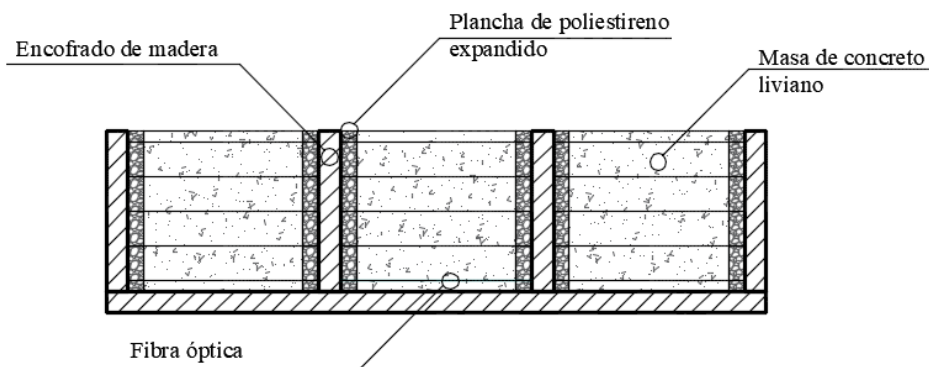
Encofrado y armado de bloques de CAP con fibra óptica
